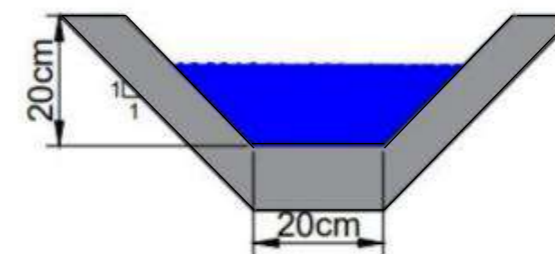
Sección correspondiente al drenaje longitudinal tanto en tramo 1 como en tramo 2 Fuente: Elaboración propia
